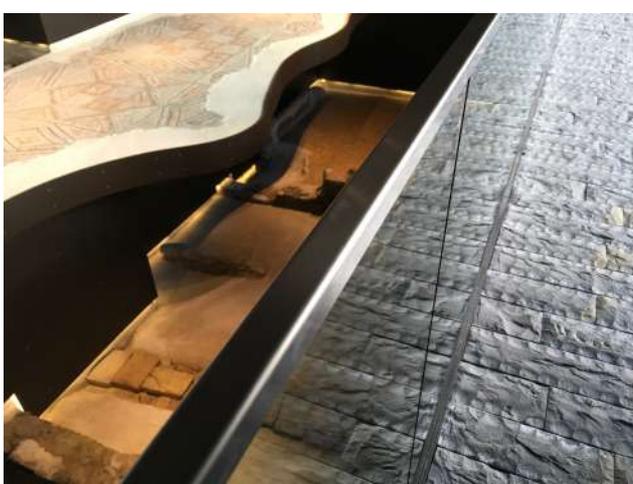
Parapetto in vetro con profili cromati arrotondati.
